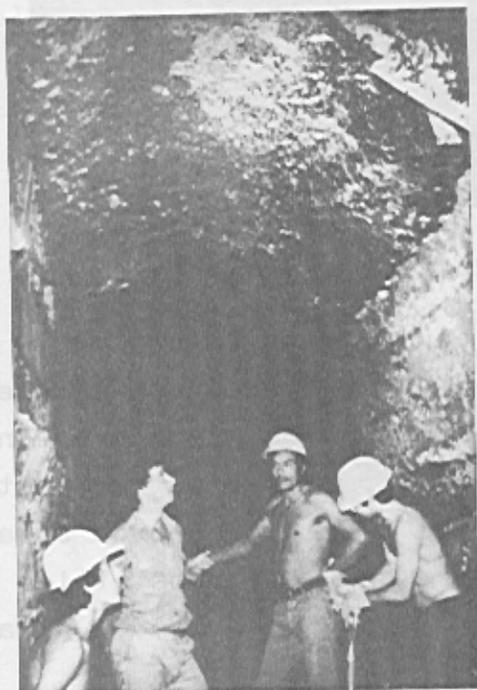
Detalhe da abóboda. Galeria terminada.
